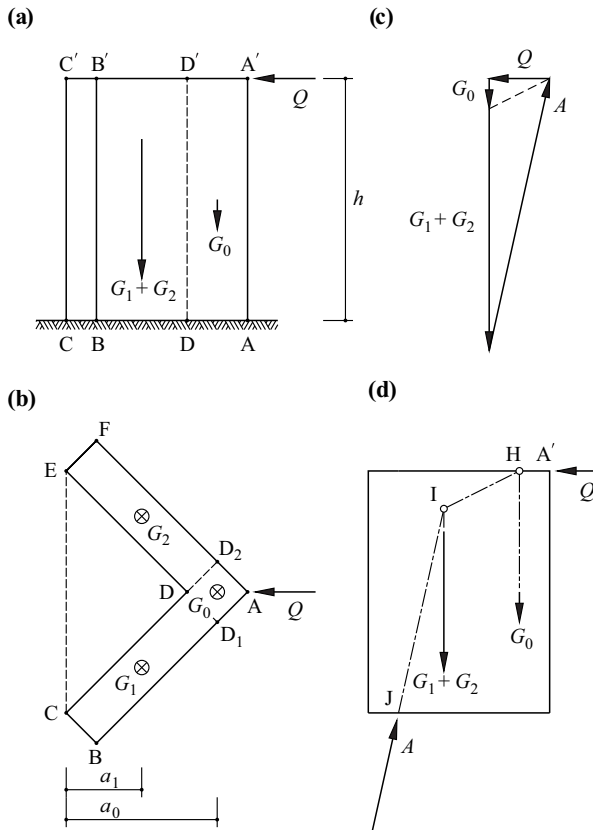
Winkel auf horizontaler Unterlage: (a) Aufriss; (b) Grundriss; (c) Kräfteplan; (d) Lageplan.
